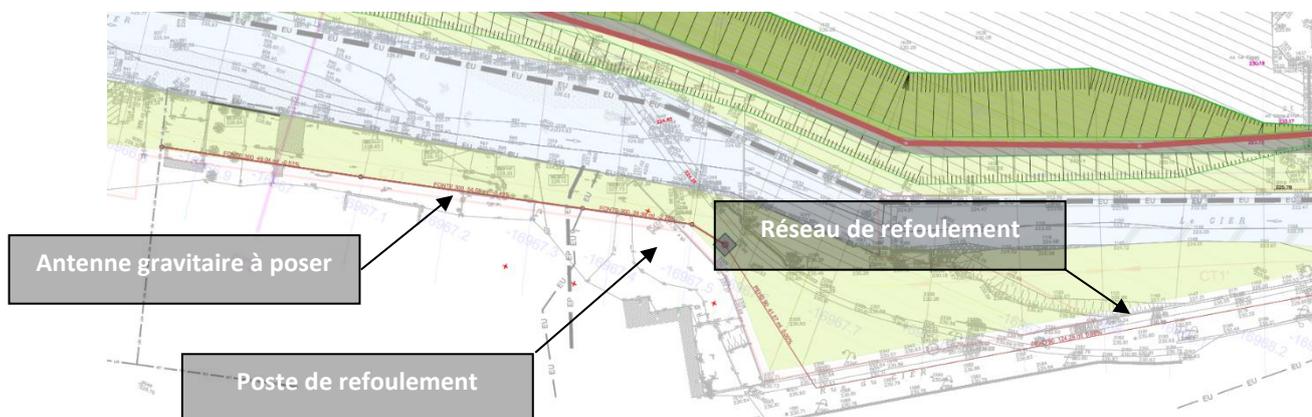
Plan de dévoiement de l'antenne EU rive droite (sans échelle)
